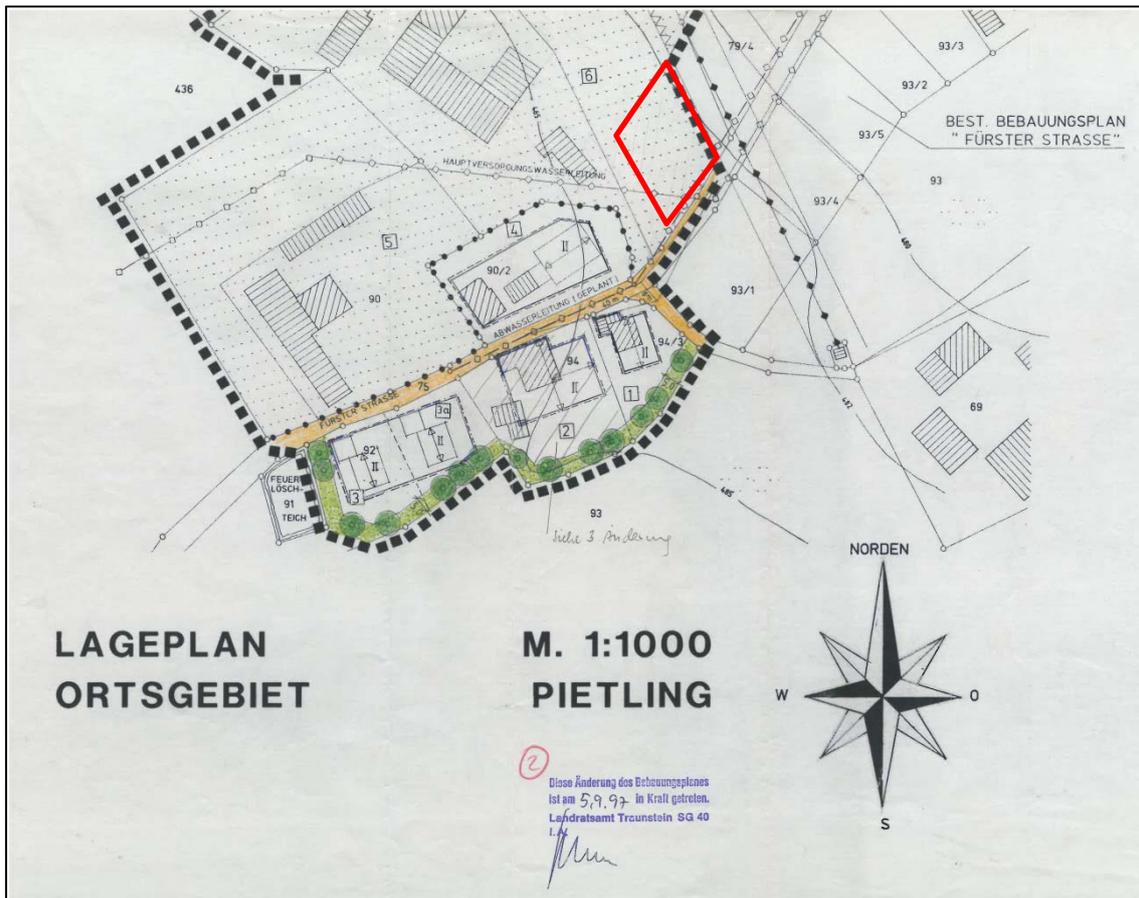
Erste Änderung des Bebauungsplanes "Pietling – Fürster Straße", in Kraft getreten am 5.9.1997
